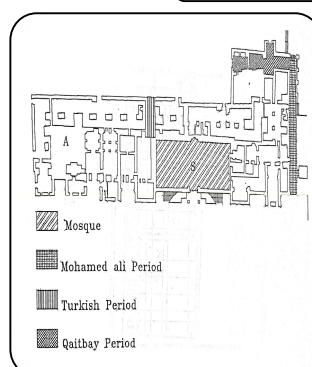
مسقّط فقي للدور الأول لمصنع الكسوة
